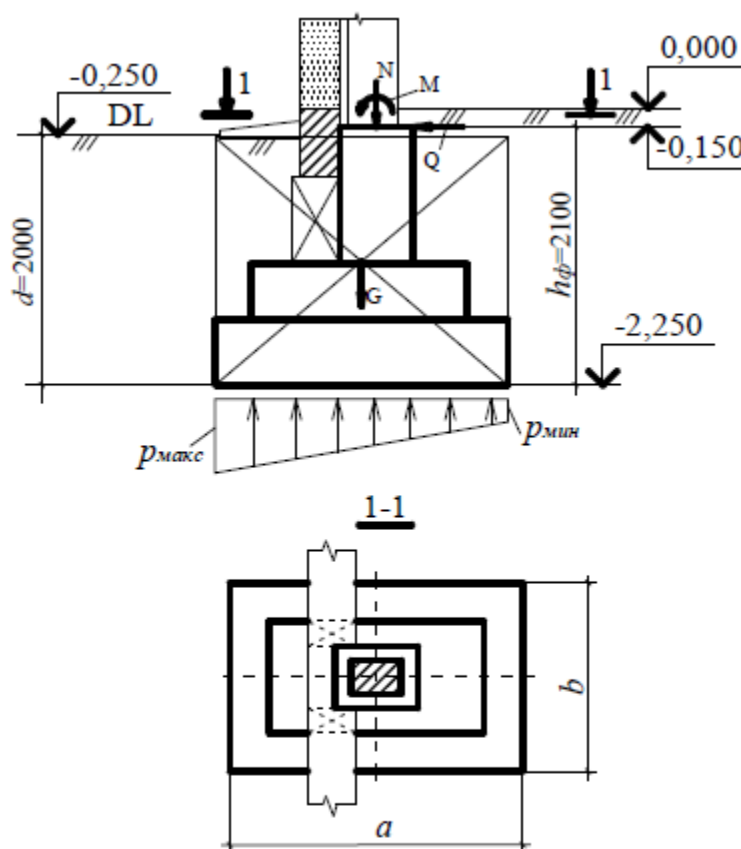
Схема к определению размеров подошвы фундамента под колонну промышленного здания (пример 5)
